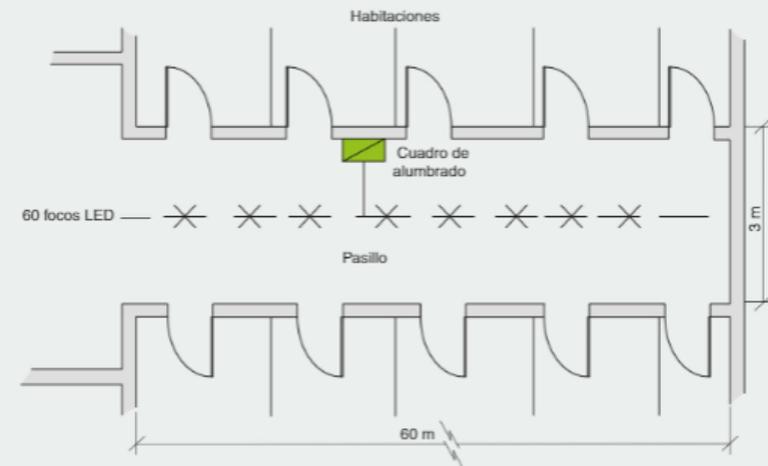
Esquema de distribución en planta de la instalación de iluminación led.
